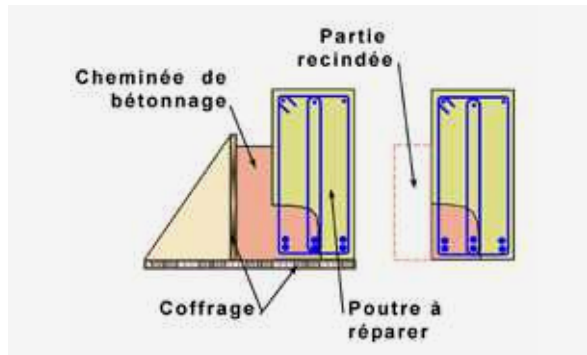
principe de la cheminée de bétonnage pour la réparation d'une poutre
